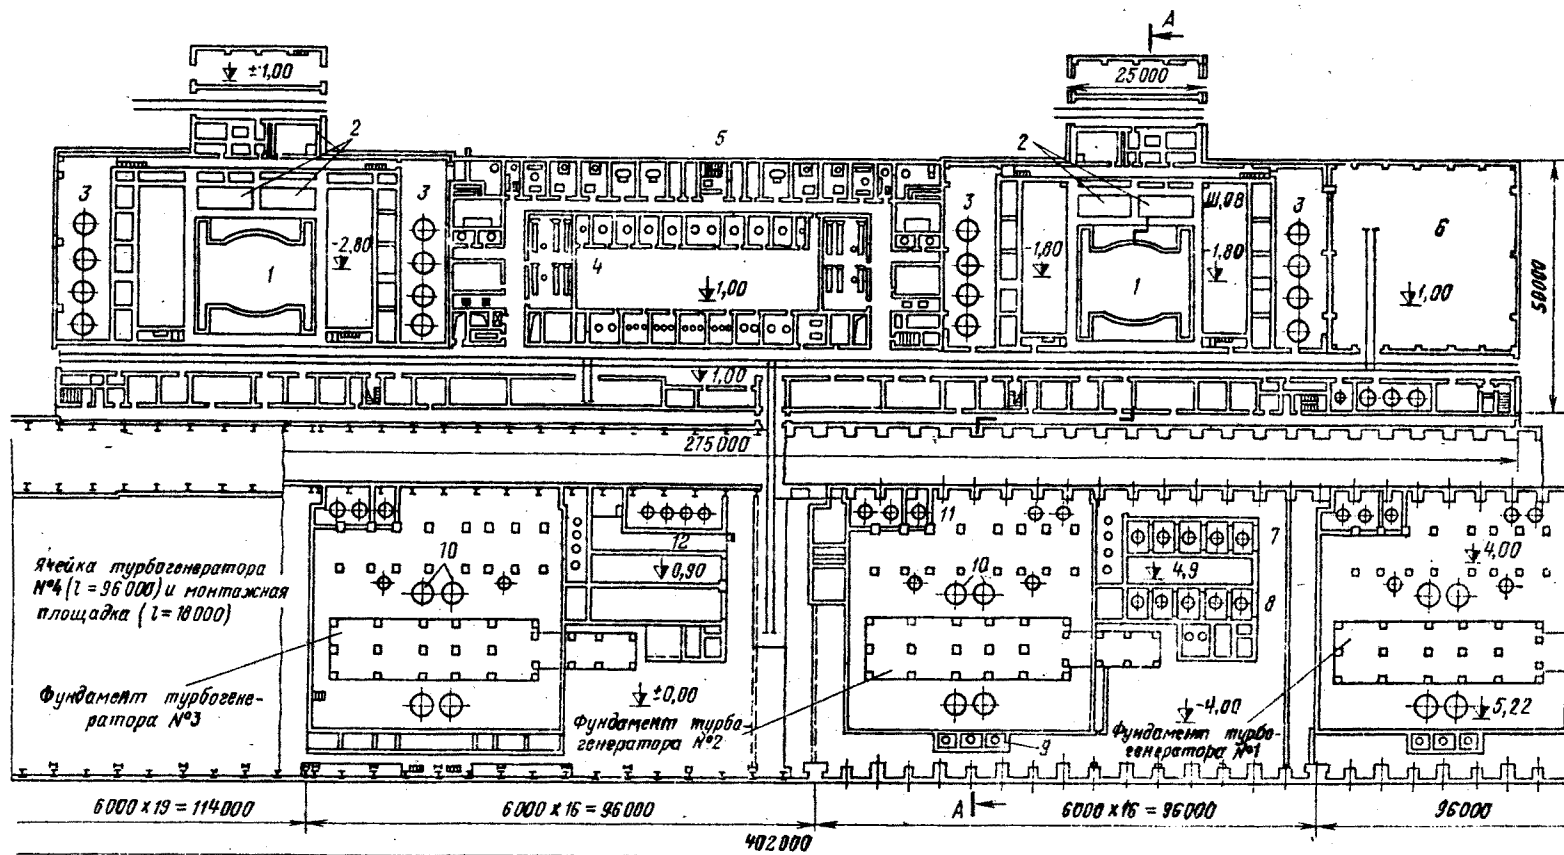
План главного корпуса АЭС с реакторами РБМК-1000:
